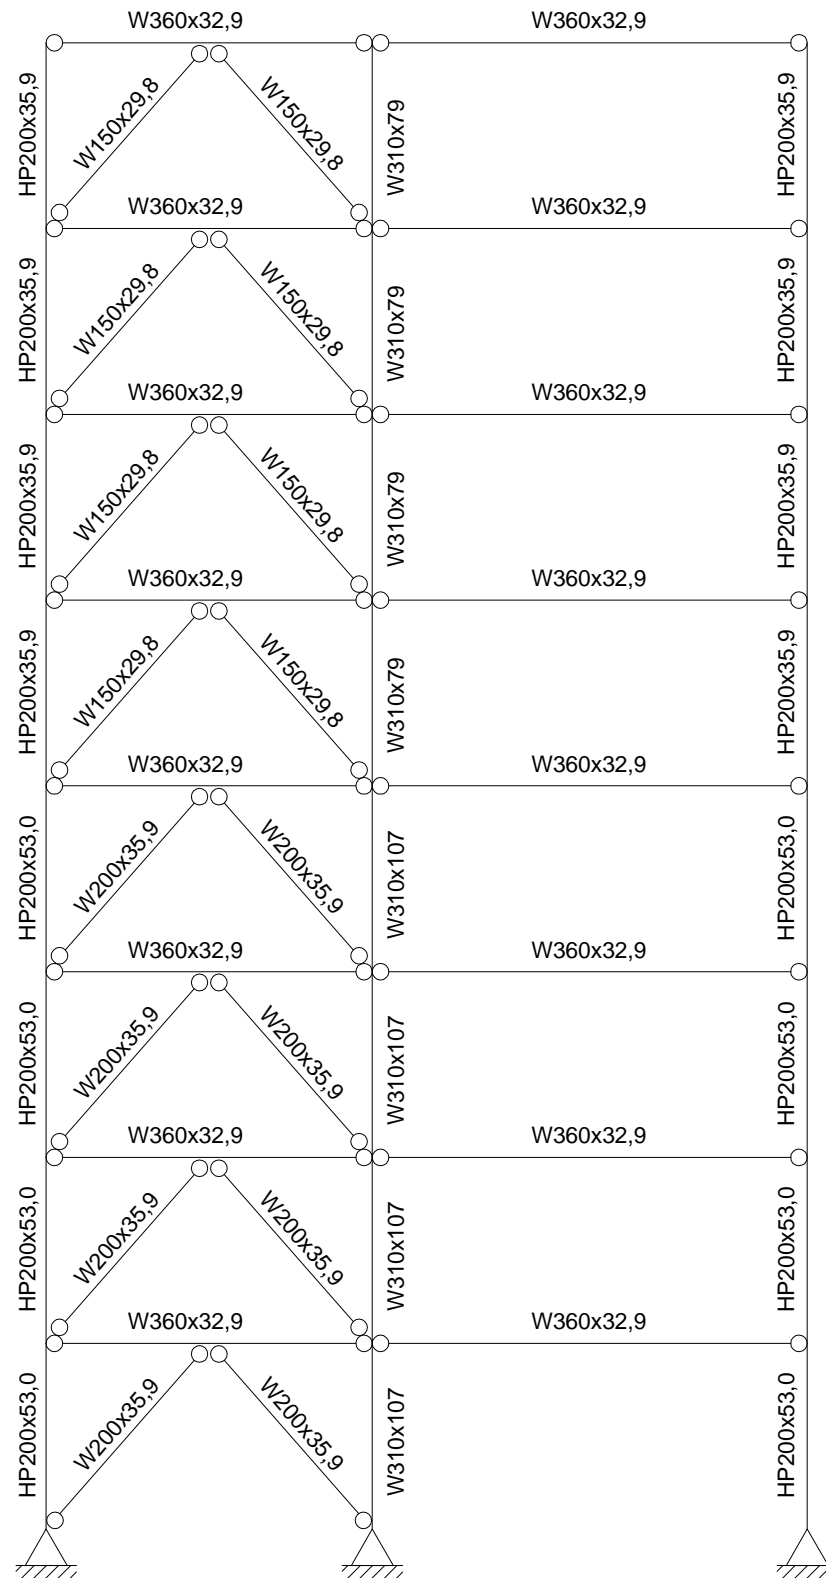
Modelo estrutural e seções adotadas para as barras do pórtico plano de oito pavimentos.
